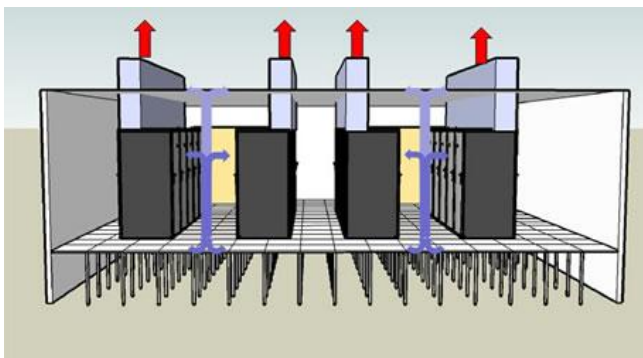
Vista da aplicação de um sistema VED (Simeon, 2013).
